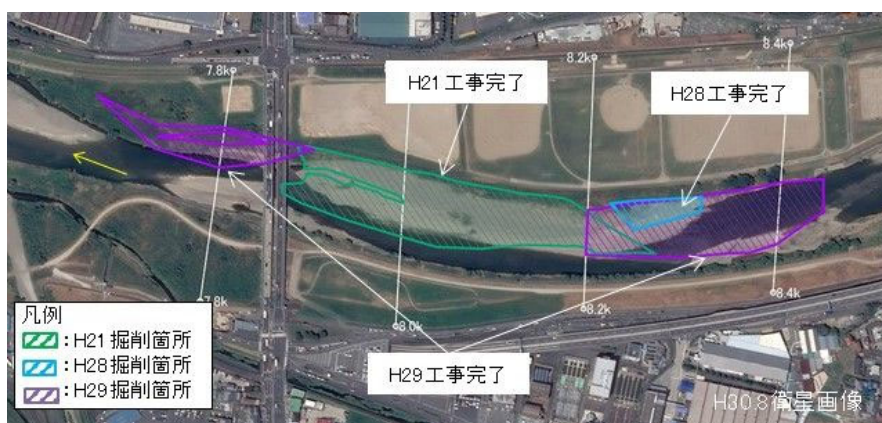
北伊丹地区周辺の工事箇所平面図
